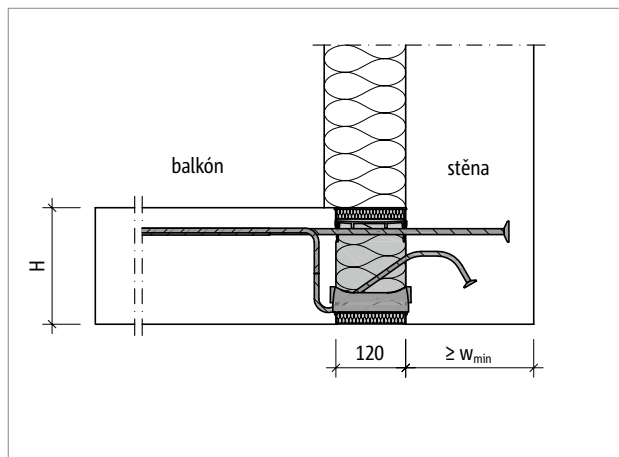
Schöck Isokorb® XT typ KL-U: Kotvení do stěny nad úrovní balkónu, vnější zateplení
